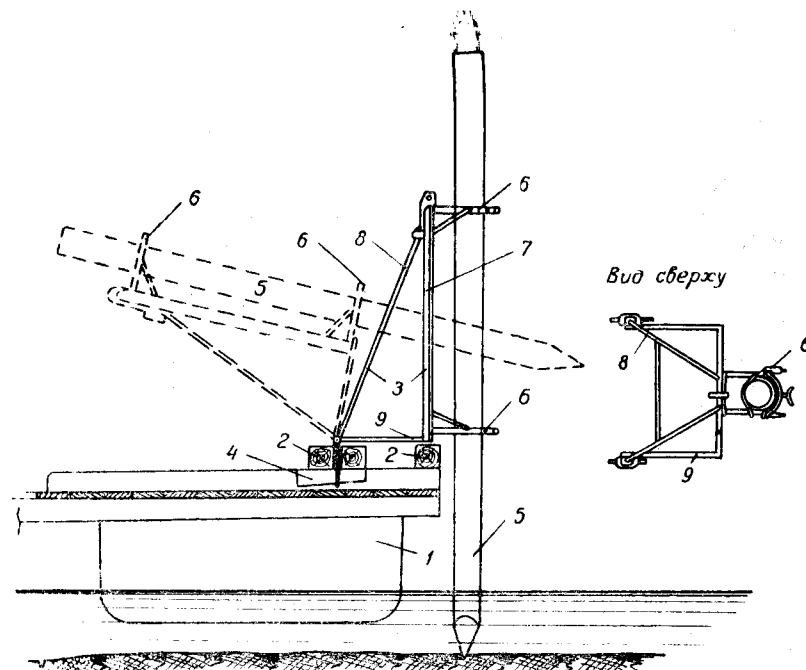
Приспособление для установки свай ПУС-1 (пунктиром показано положение ПУС во время укладки свай):
